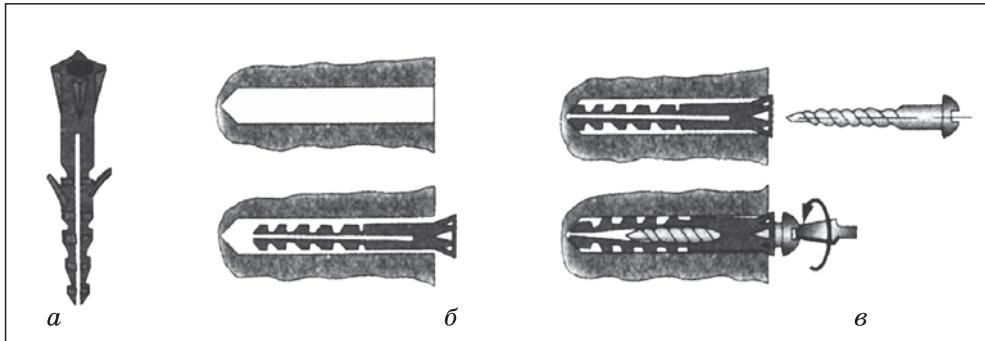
Внешний вид пластмассовой пробки (дюбеля) (а); ее установка в отверстие (б) и завинчивание крепежного шурупа (в)
